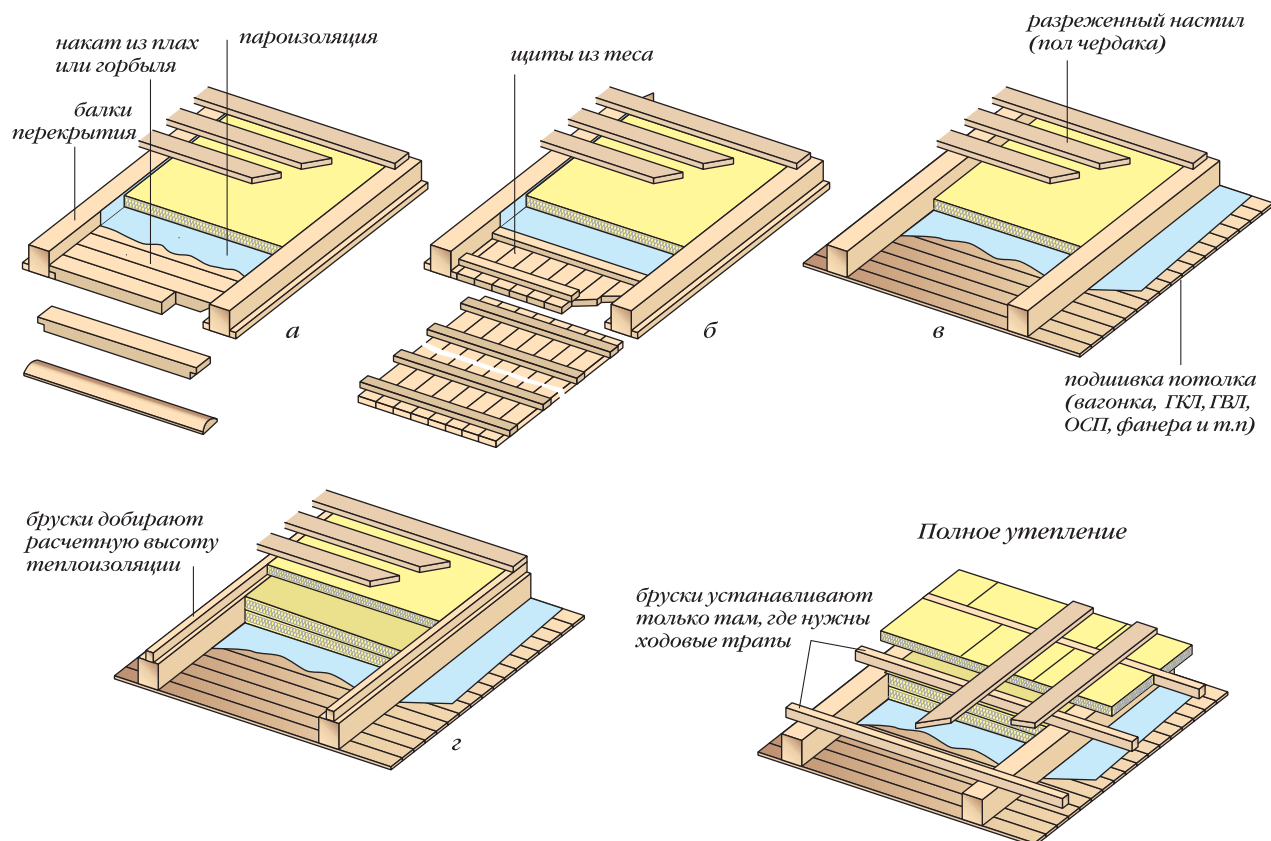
Варианты теплоизоляции чердачного перекрытия по деревянным балкам
